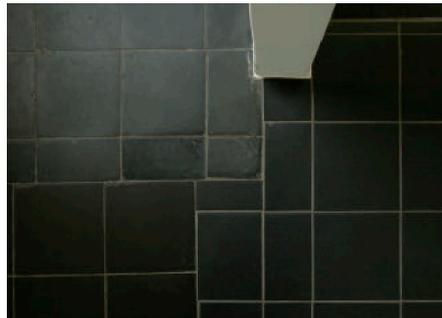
Fotografías de los restos y la restauración pavimento obtenidos en la restauración de las viviendas 14 y 15 de la Weissenhof.
